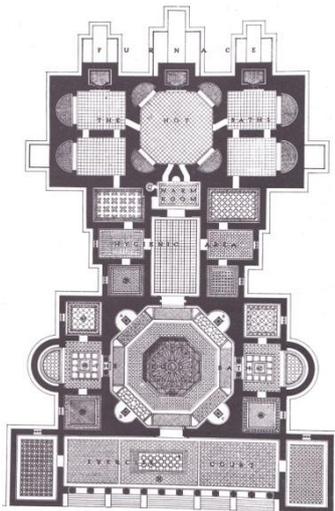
Grundriss der Badeanlage in Antiochia [Kiby S.77]
